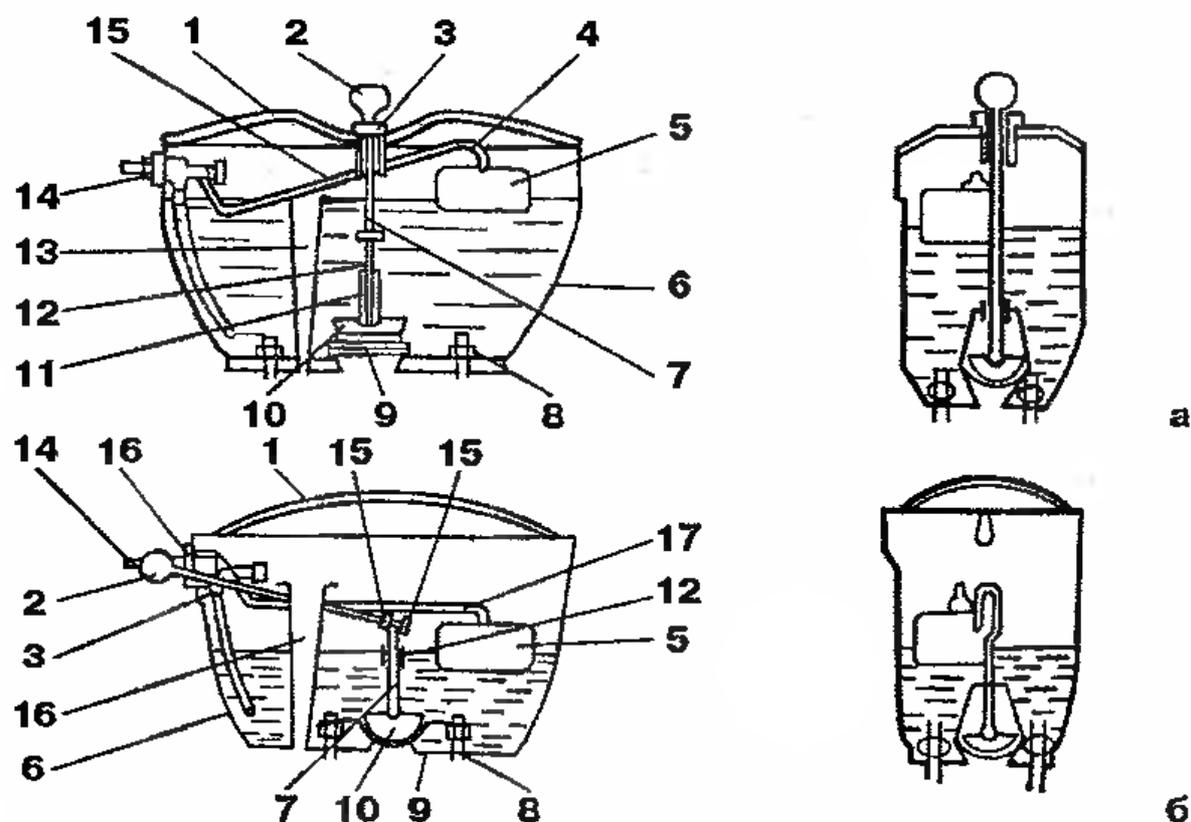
Устройство сливных бачков с боковым подводом воды: а — с верхним пуском; б — боковым пуском; 1 — крышка бачка; 2 — кнопка пуска; 3 — гайка; 4 — рычаг клапана; 5 — поплавок; 6 — корпус; 7 — тяга; 8 — крепление к унитазу; 9 — седло; 10 — клапан; 11 — крепление клапана; 12 — направляющие; 13 — перелив; 14 — подвод воды; 15 — шайба; 16 — поплавковый клапан; 17 — рычаг поплавка
